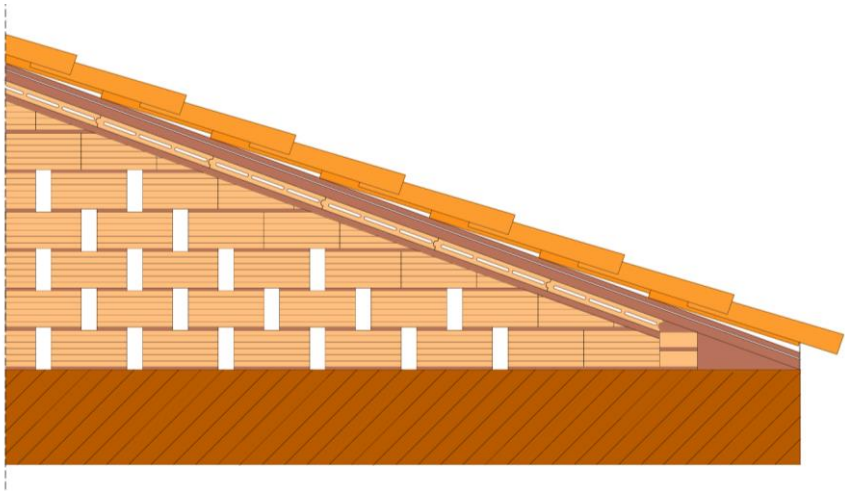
Detalle cubierta. 2024. Fuente: Propia
